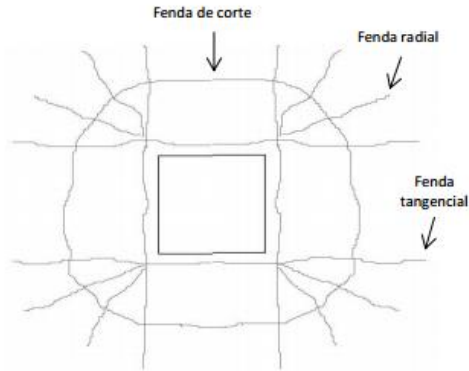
Fendas na face superior da ligação laje-pilar [adaptado de 17]
